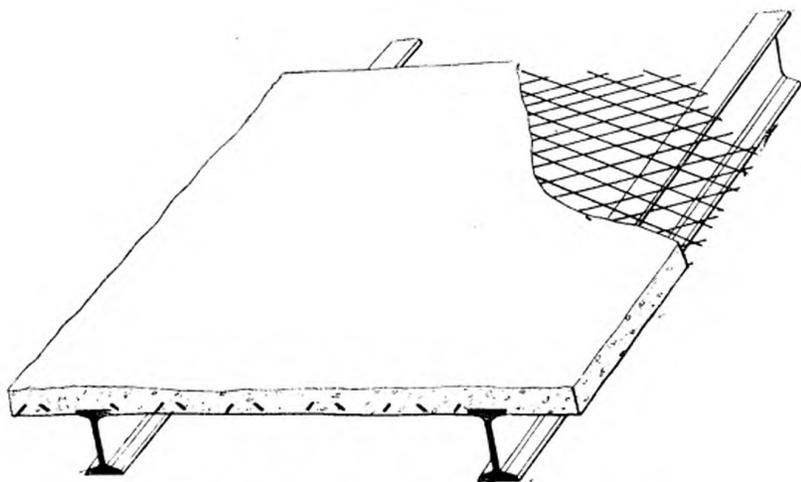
Plancher en béton armé après enlèvement du cintre.
